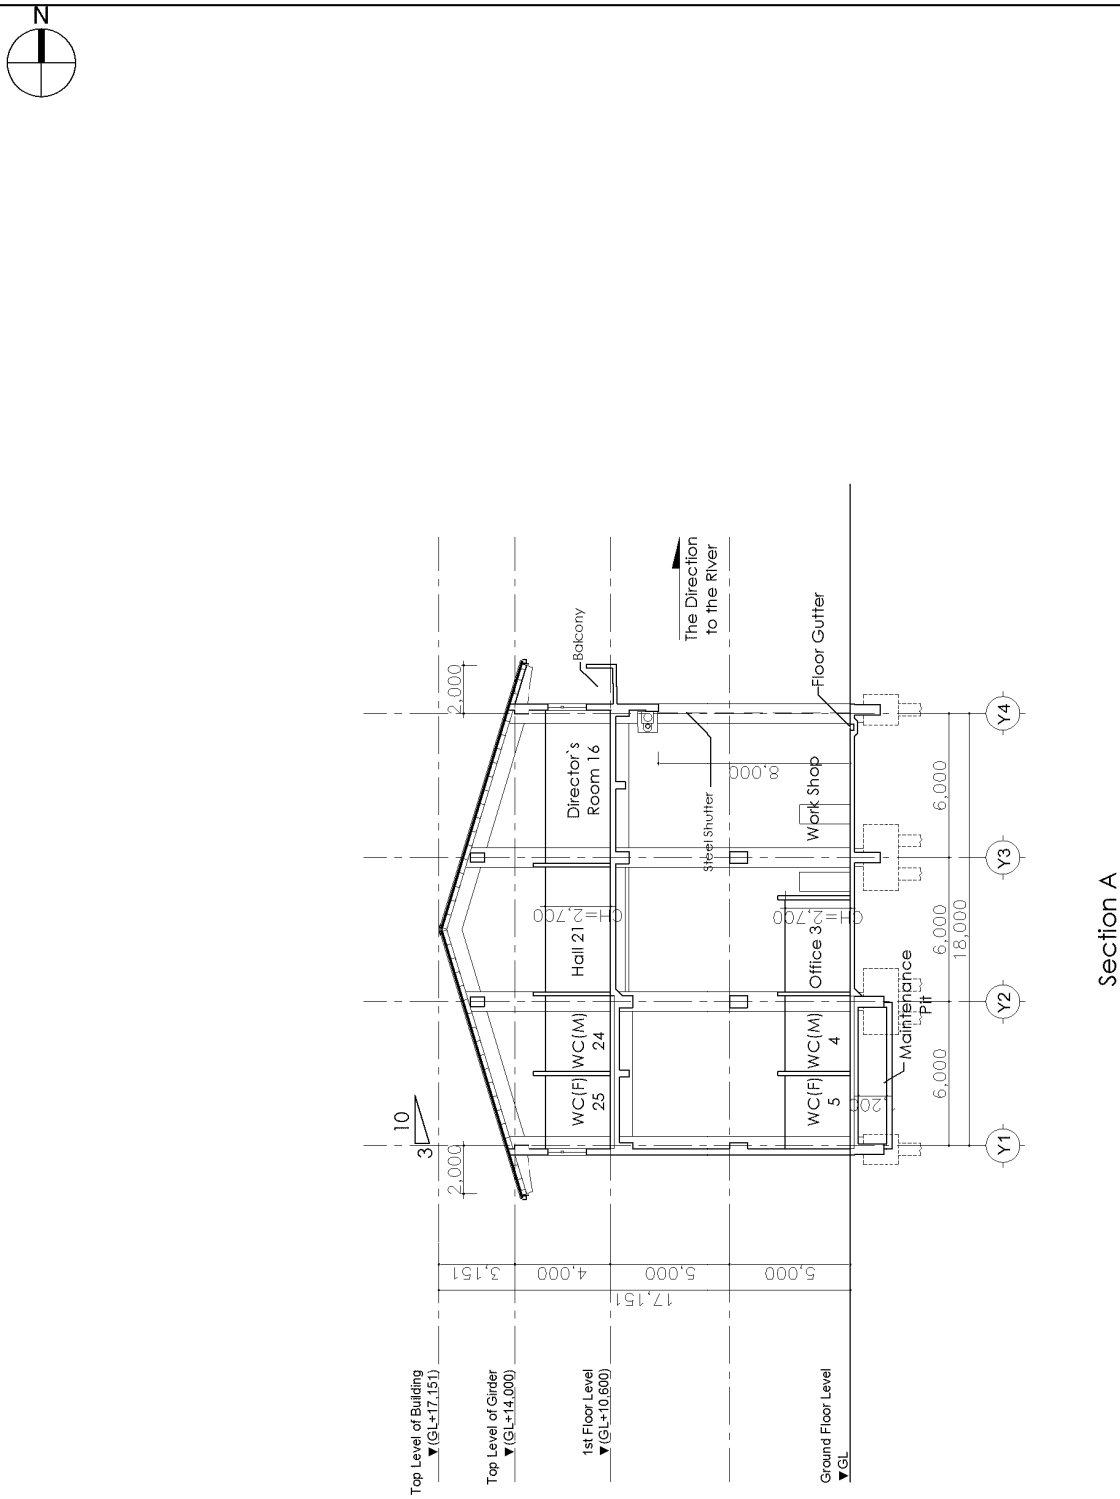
港湾事務所／ワークショッップ 断面図 (1/2)
